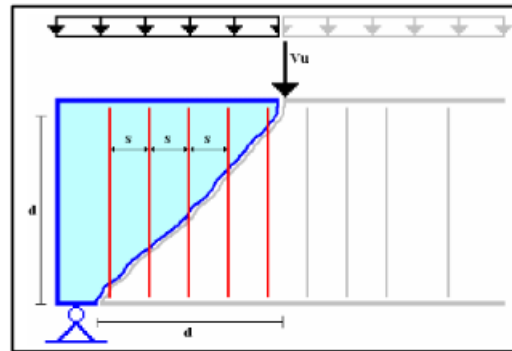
Estribos transversales que cruzan las fisuras de Cortante:
